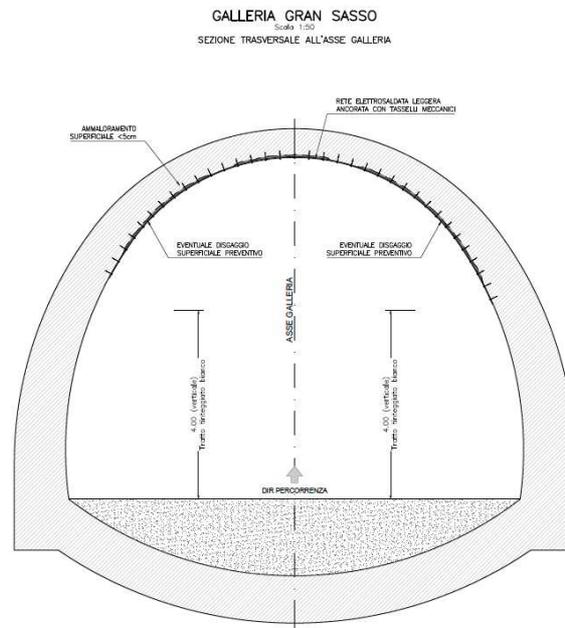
Rappresentazione tipologica su sezione trasversale galleria
